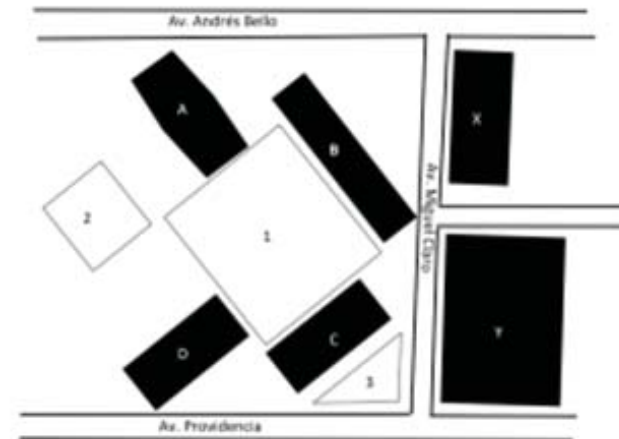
Esquema Torres de Tajamar A.- Torre A. B.- Torre B. C.- Torre C. D.- Torre D. X.- Edificio Porvenir. Y.- Edificio Veneto. 1.- Plaza Torres de Tajamar. 2.- Plaza An) teatro. 3.- Plaza Jorge Prat
